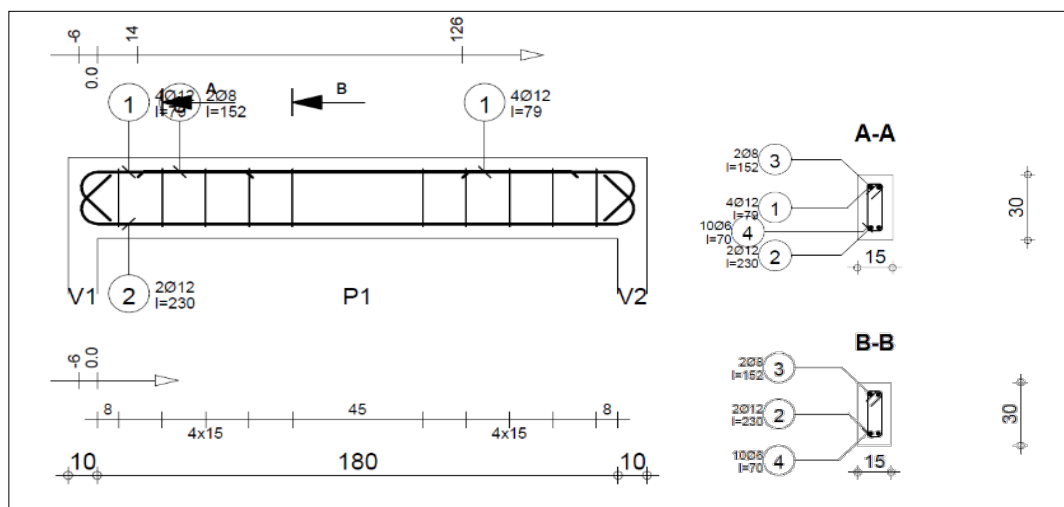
Détail de la disposition des armatures dans les poutres en béton armé.
